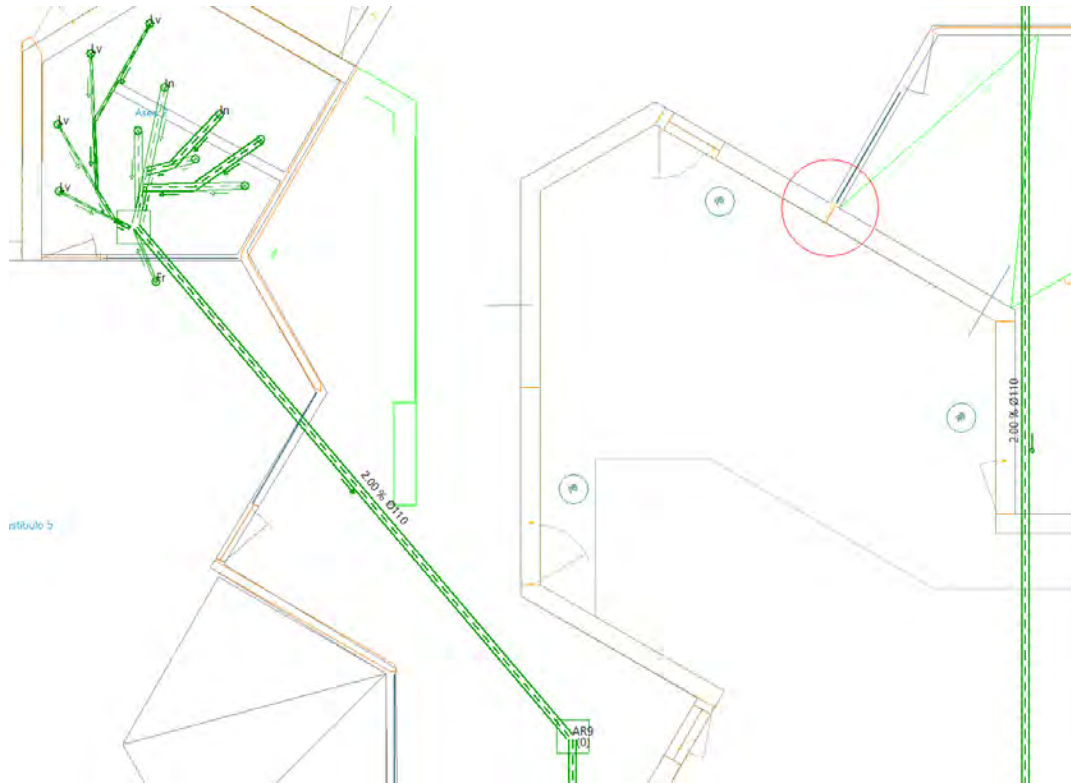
Plano detalle – Saneamiento (Ejemplo distribución local húmedo)
